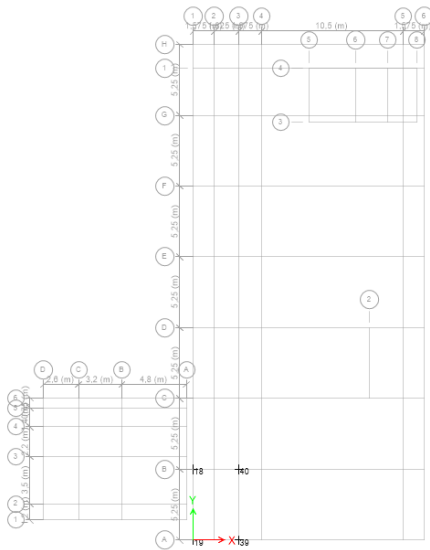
Layout Struktur pada Elev. +0,00 Gedung A
